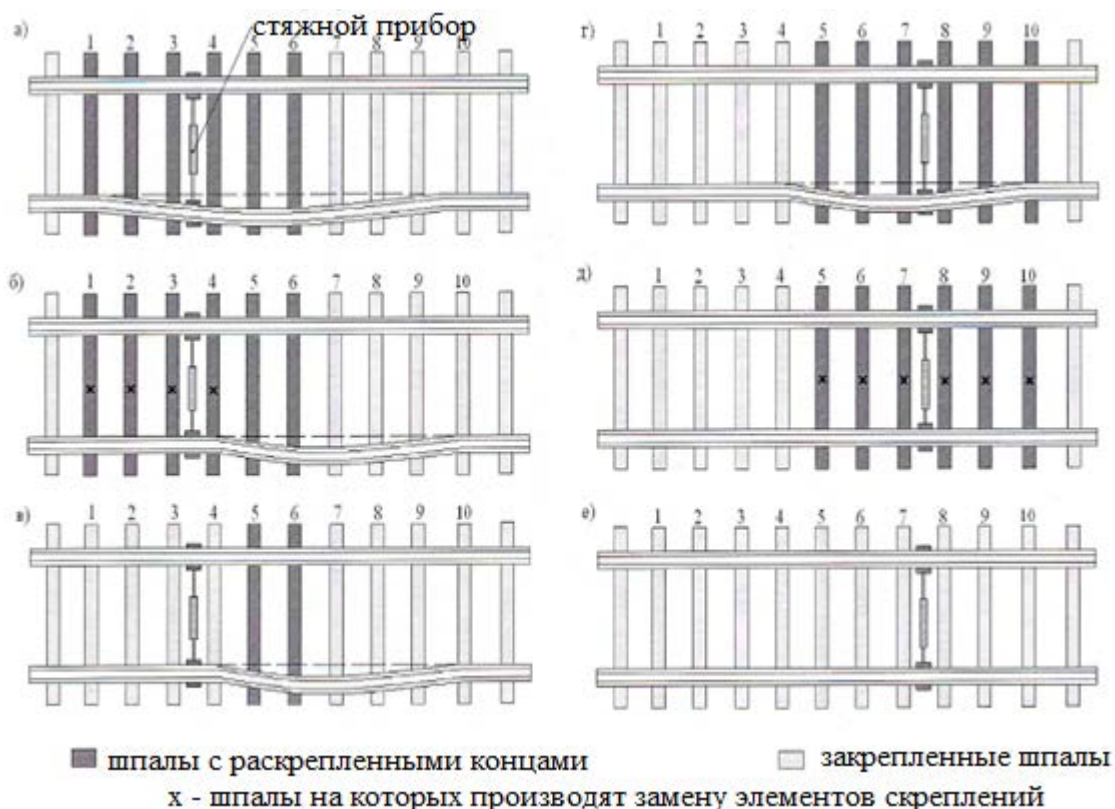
Схема установки стяжного прибора и порядок регулировки ширины колеи:
